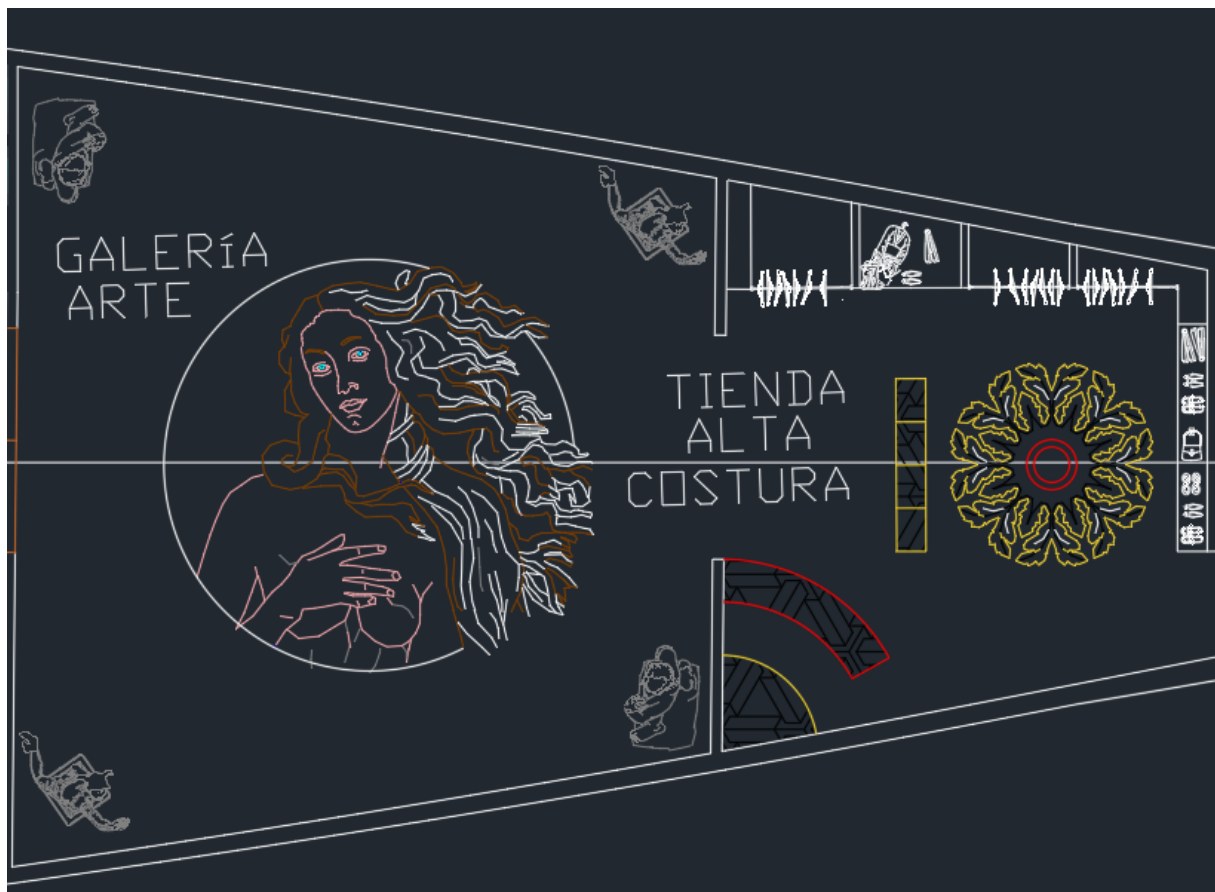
Cubierta Sun Deck Galería de Arte y Tienda Alta Costura
